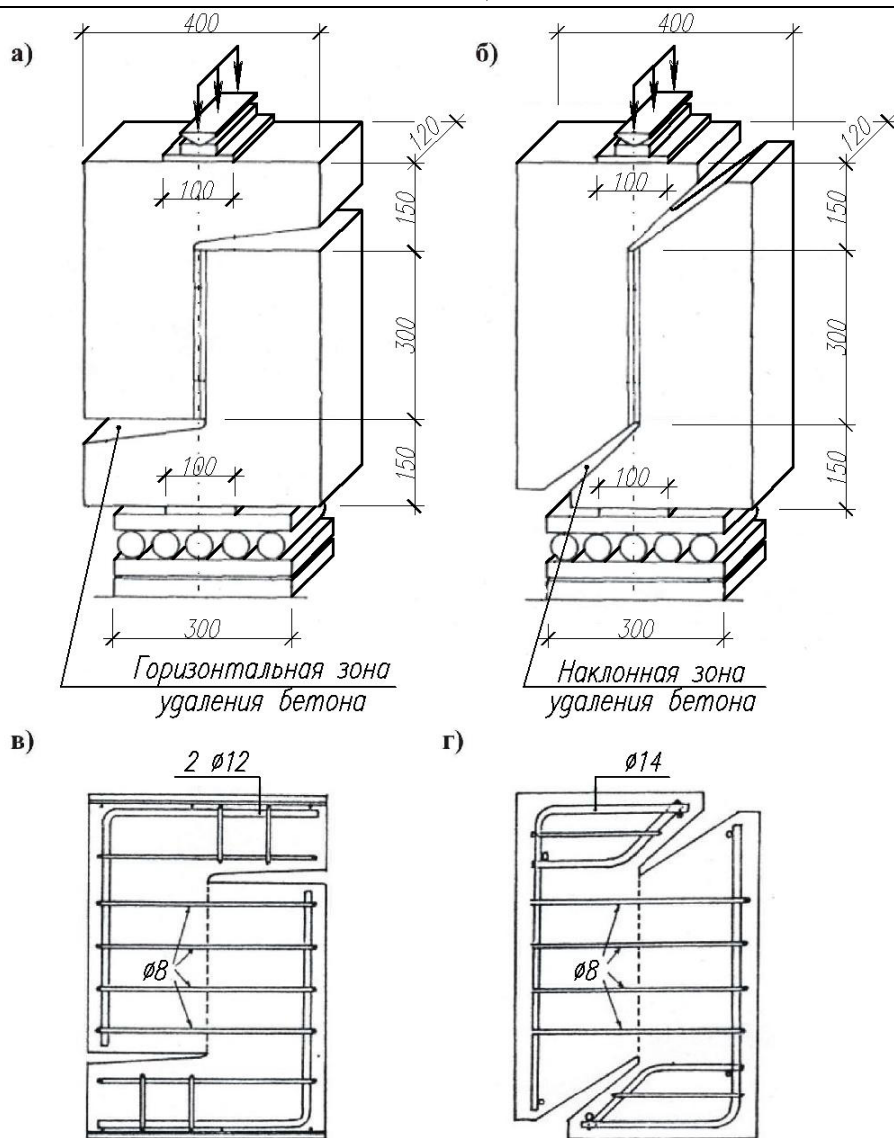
Конструктивное решение и схема нагружения эталонных железобетонных образцов:
